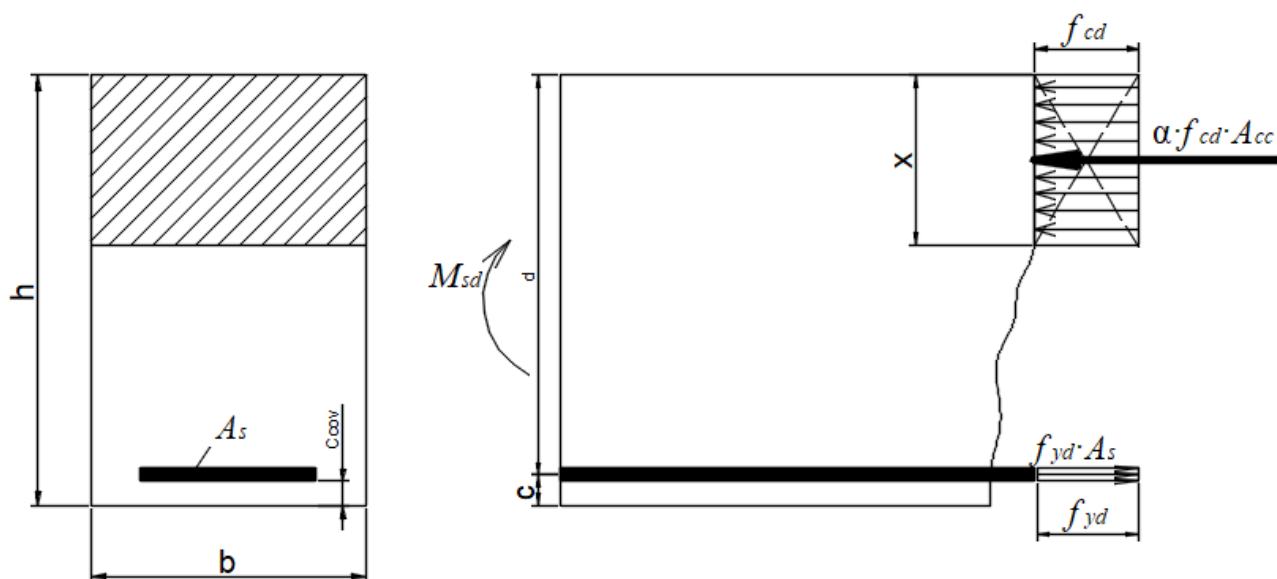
Расчетное предельное состояние прямоугольного сечения с одиночной арматурой
